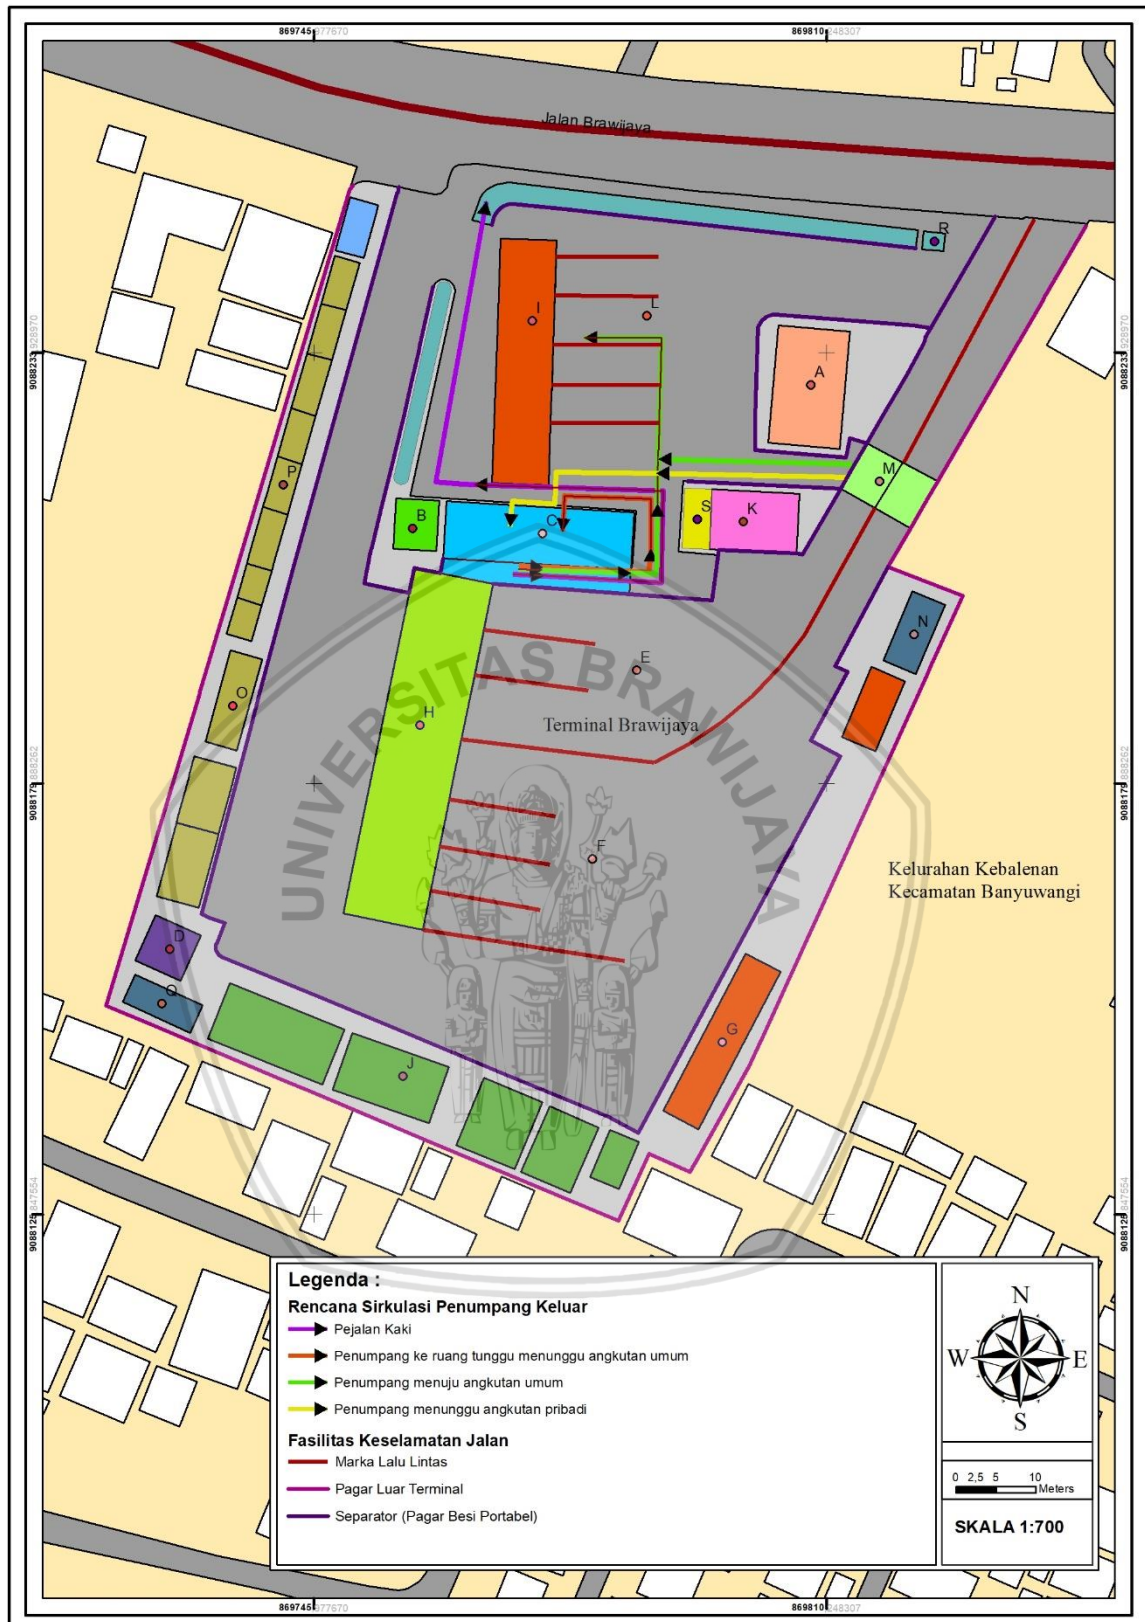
Rencana Ruang dan Sirkulasi Terminal Brawijaya
